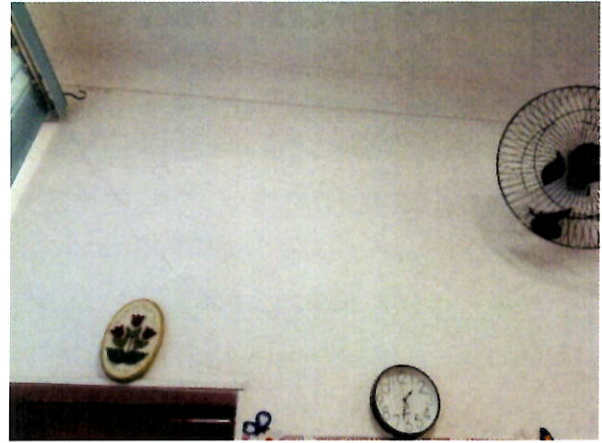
Fissuras observadas em sala no pavimento térreo.
